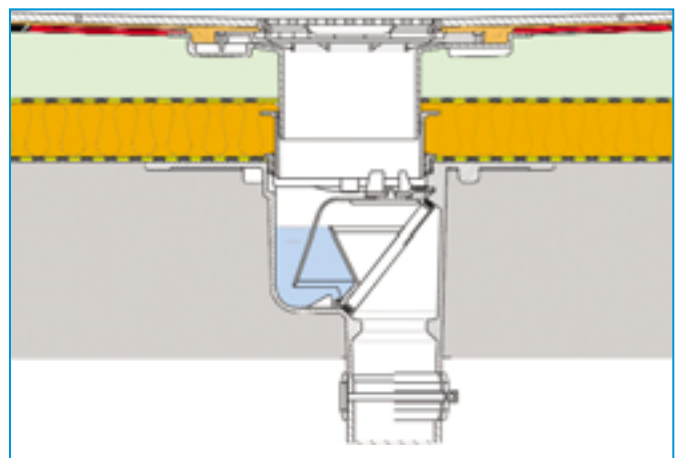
Bodenablauf mit Klebe-/Pressdichtungsflansch, Typ 3, mit Aufsatzstück und Anschlussmanschette in Bodenaufbau mit Abdichtung im Dünnbett
